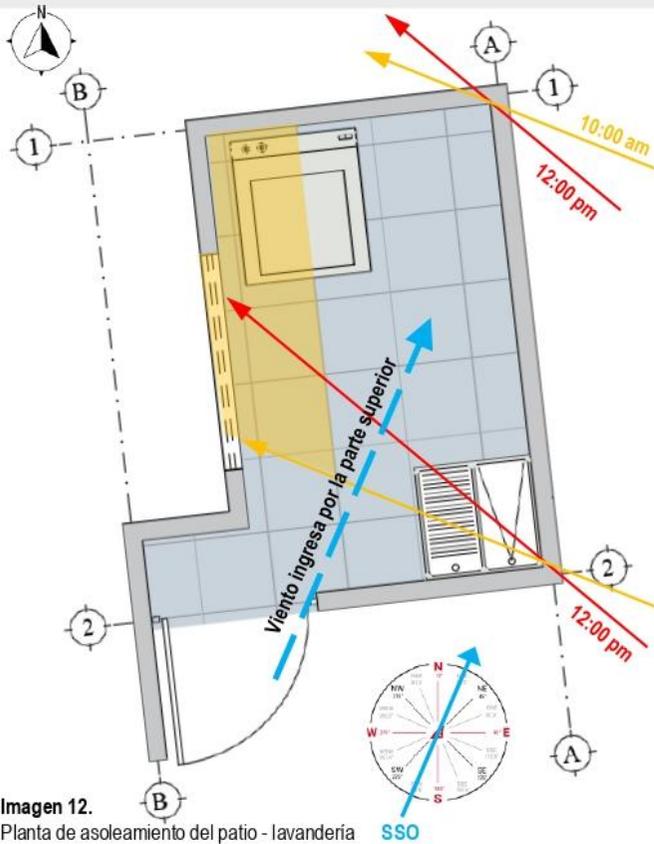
Planta de asoleamiento del patio - lavandería SSO
